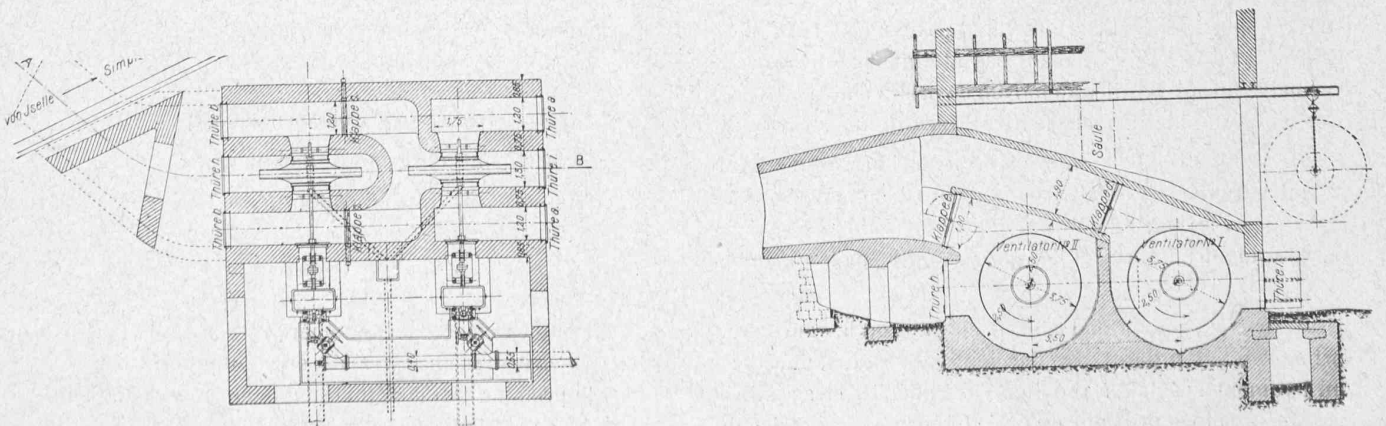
et 14. — Plan et coupe des installations de la ventilation du tunnel, côté d'Iselle.
